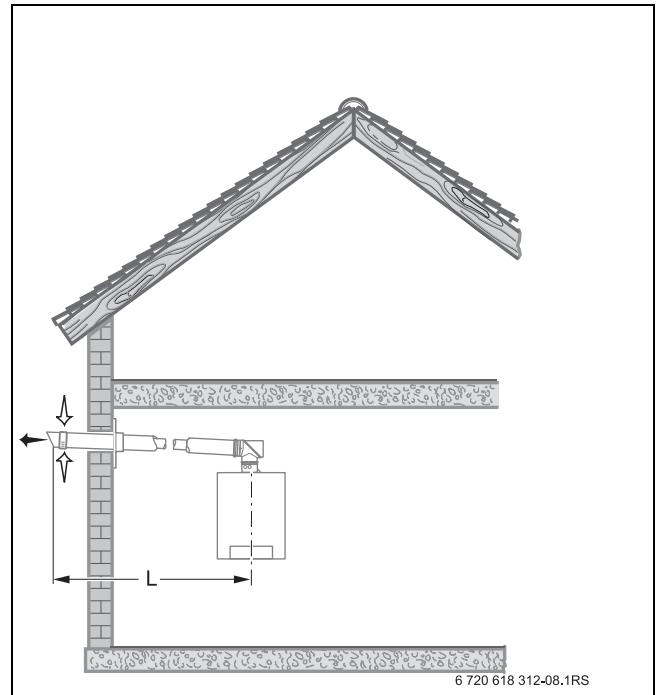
C_{13x}: Luft-/Abgasführung im konzentrischen Rohr Ø 100/150 mm waagrecht durch Fassade
